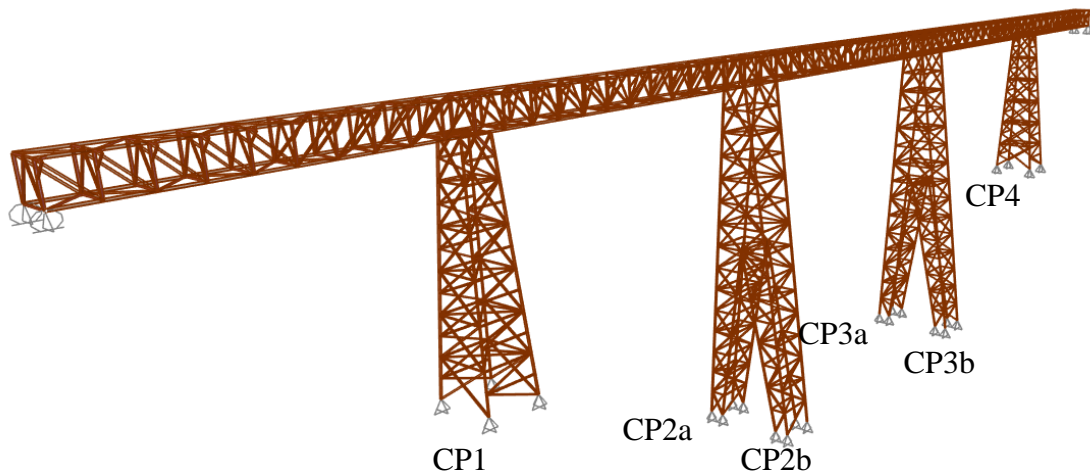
Vista 3D modelo puente diseño 1 y 2 sin acartelamiento
